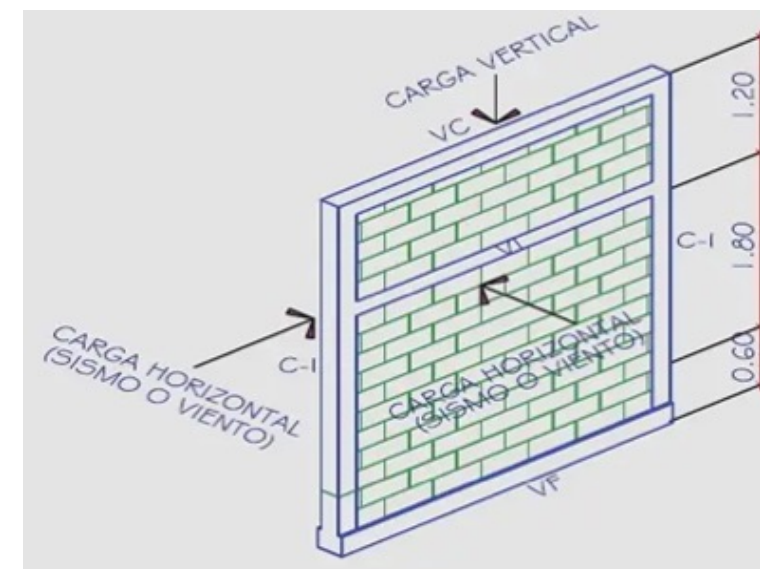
Ejemplo de muro portante, movimiento de la Mampostería.
